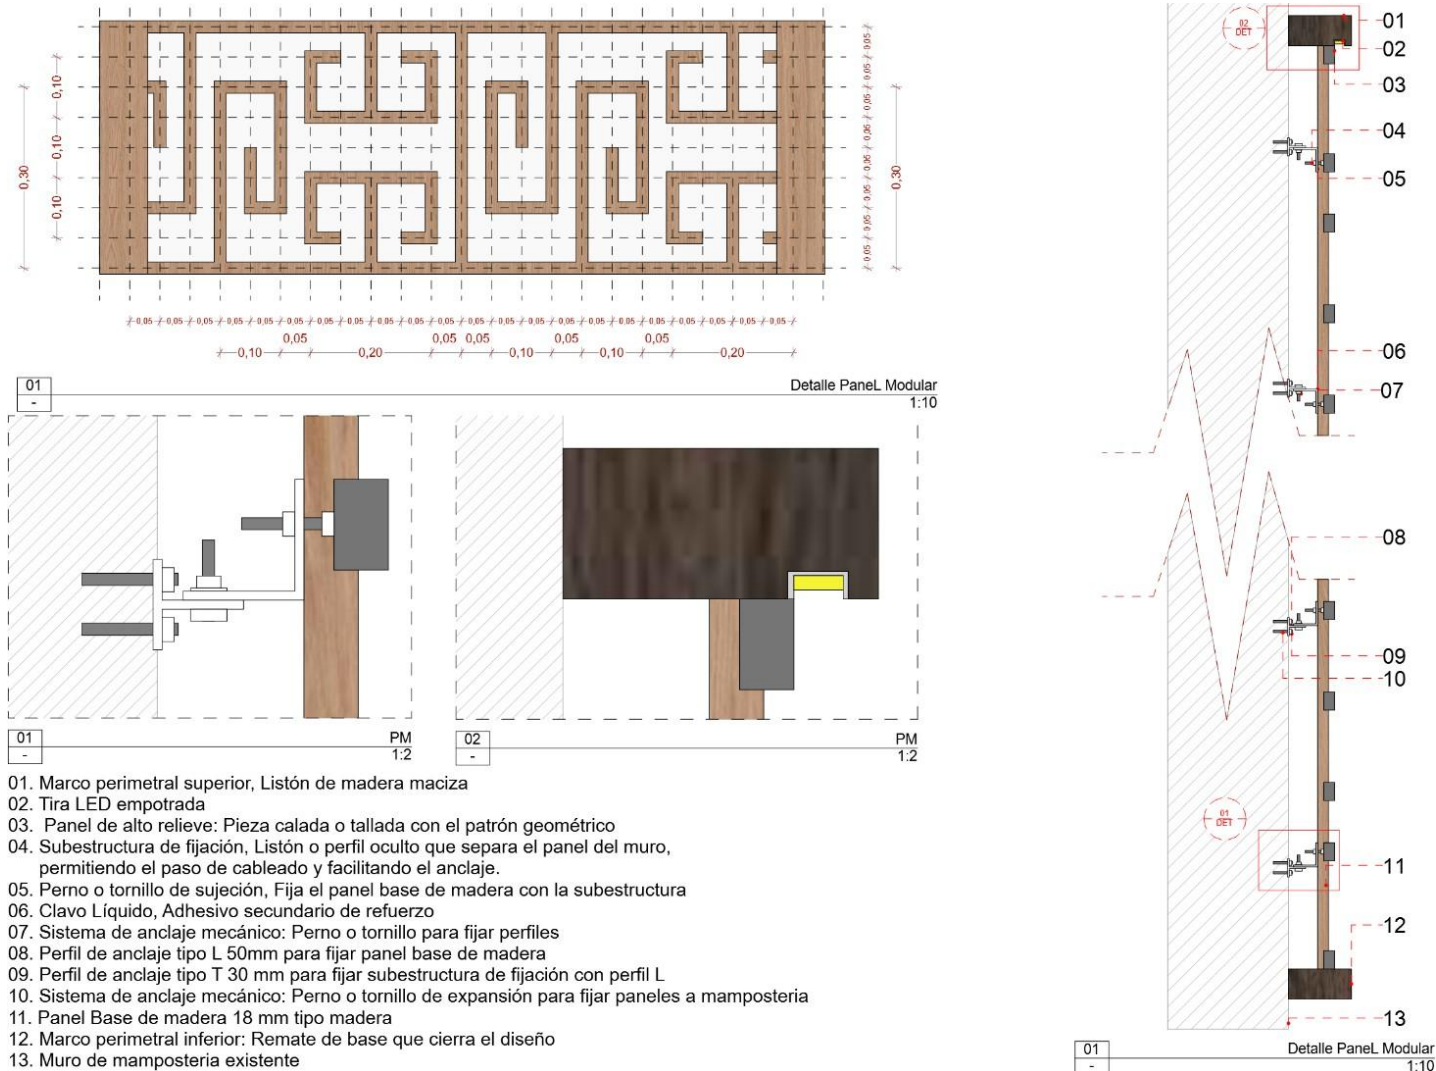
Detalles Constructivos de sistemas de Paneles modulares
